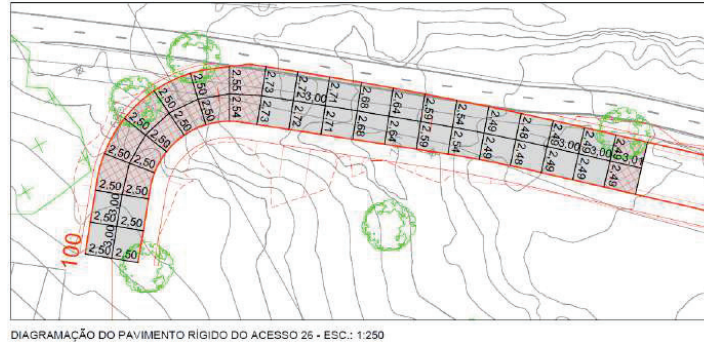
Diagrama do pavimento rígido do acesso nº26.
